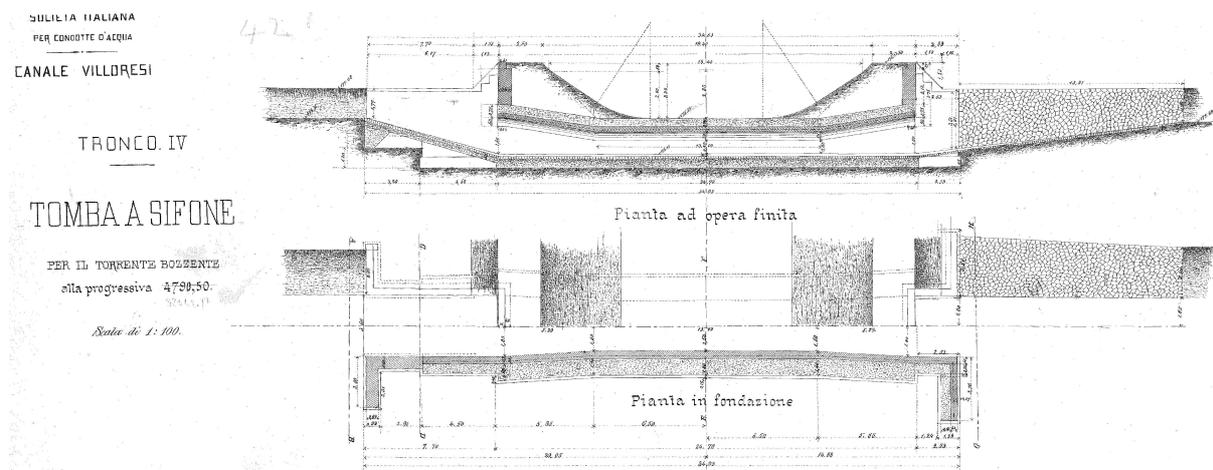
Sottopasso del Canale Villoresi – Pianta e Sezione originaria (Consorzio Villoresi)
